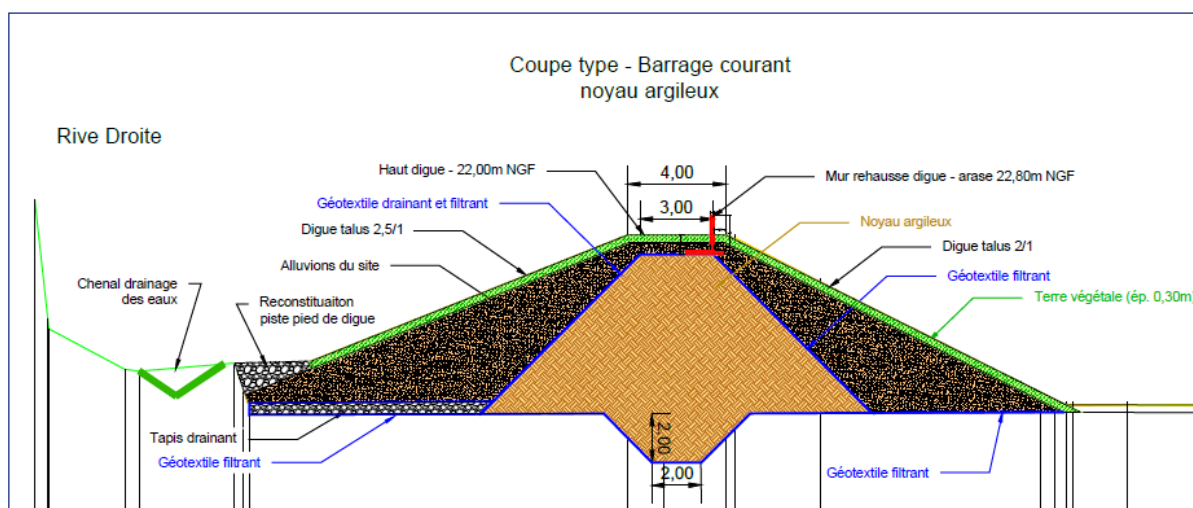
coupe de la section courante du barrage (Plans AVP)
